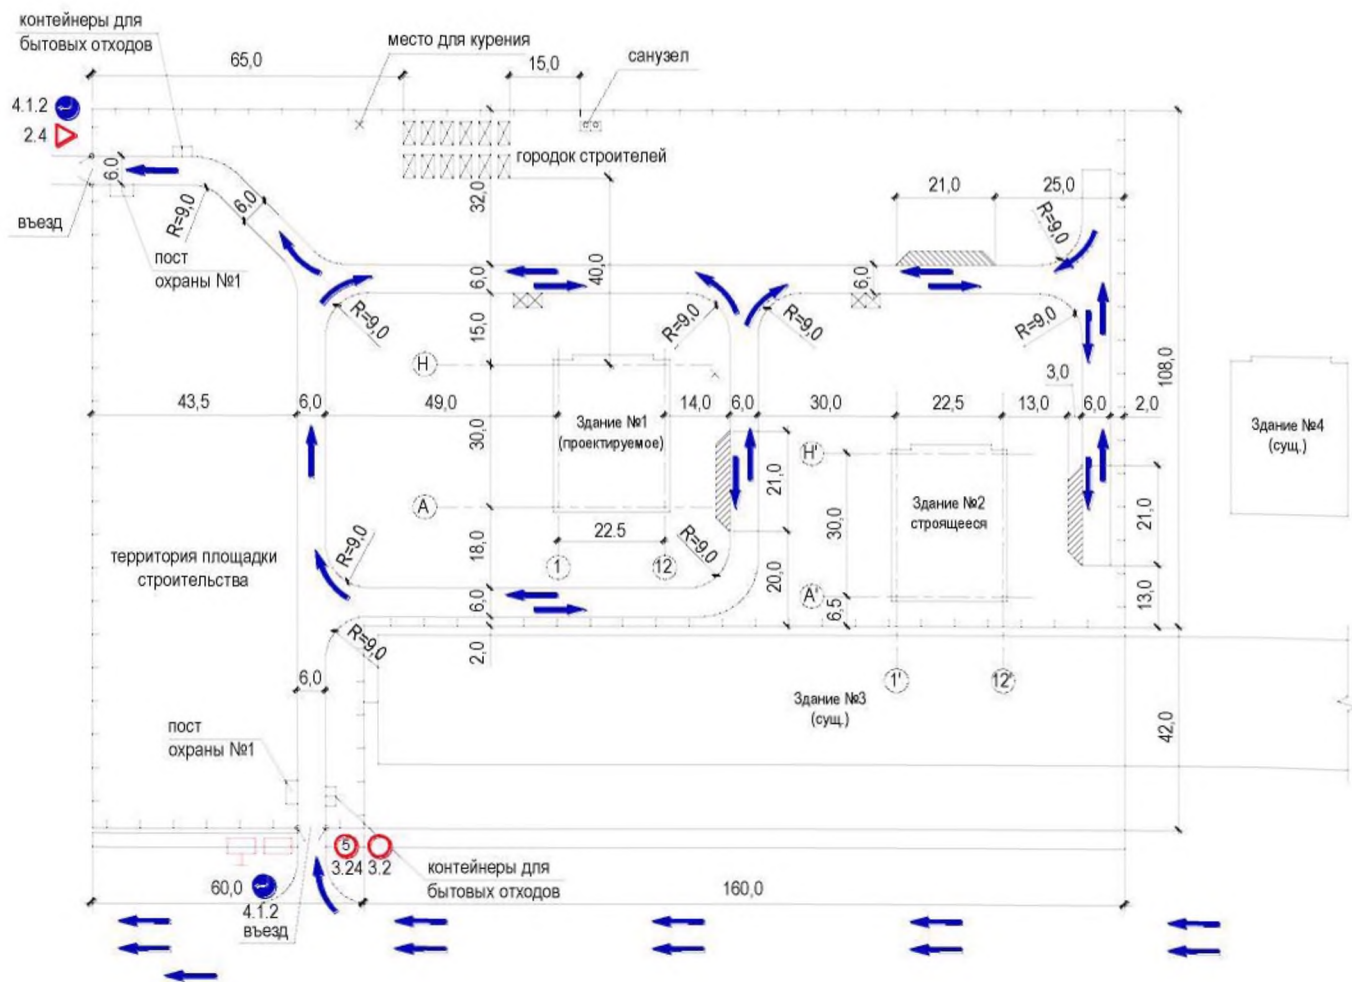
Оснащение строительной площадки контейнерами для строительного и бытового мусора.
